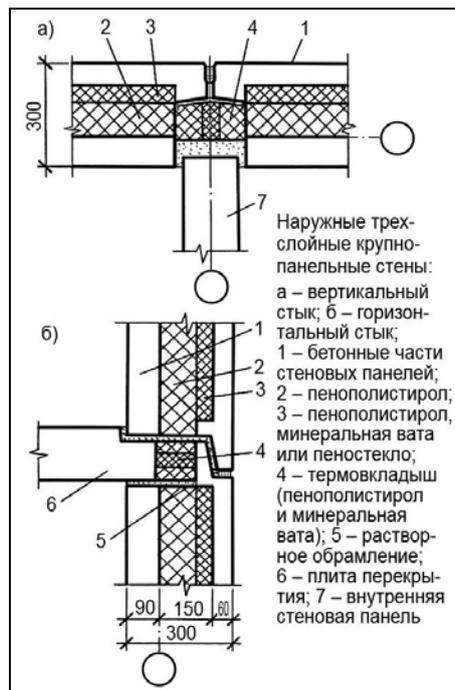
Принципиальное конструктивное решение сопряжения стеновых панелей и плиты междуэтажного перекрытия
